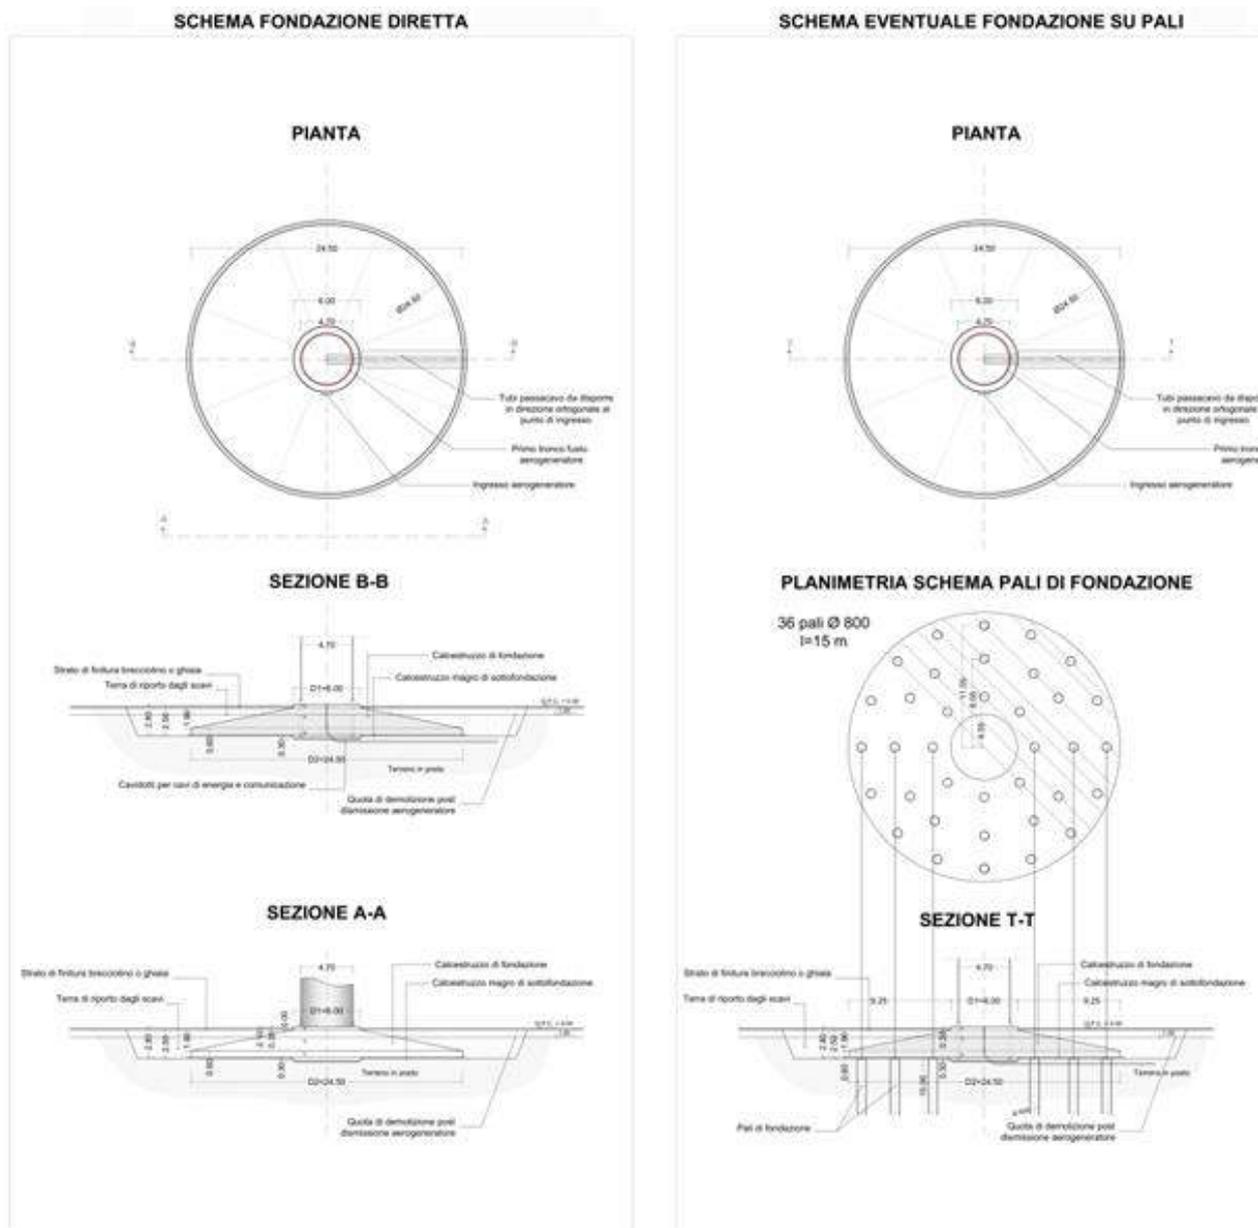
Pianta e vista della fondazione tipo dell'aerogeneratore
